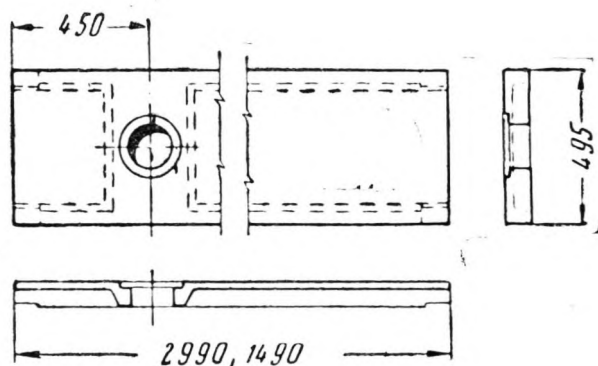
Железобетонная плита для покрытий производственных зданий с отверстием для пропуска труб внутреннего водостока
